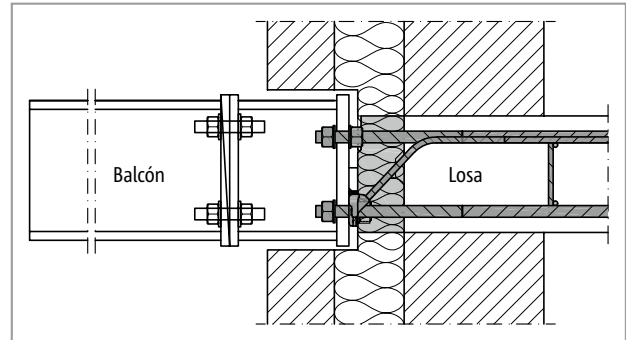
Schöck Isokorb® T tipo SK: Elemento aislante dentro del núcleo aislante; el conector in situ entre el Isokorb® y el balcón proporciona flexibilidad en el proceso de construcción
